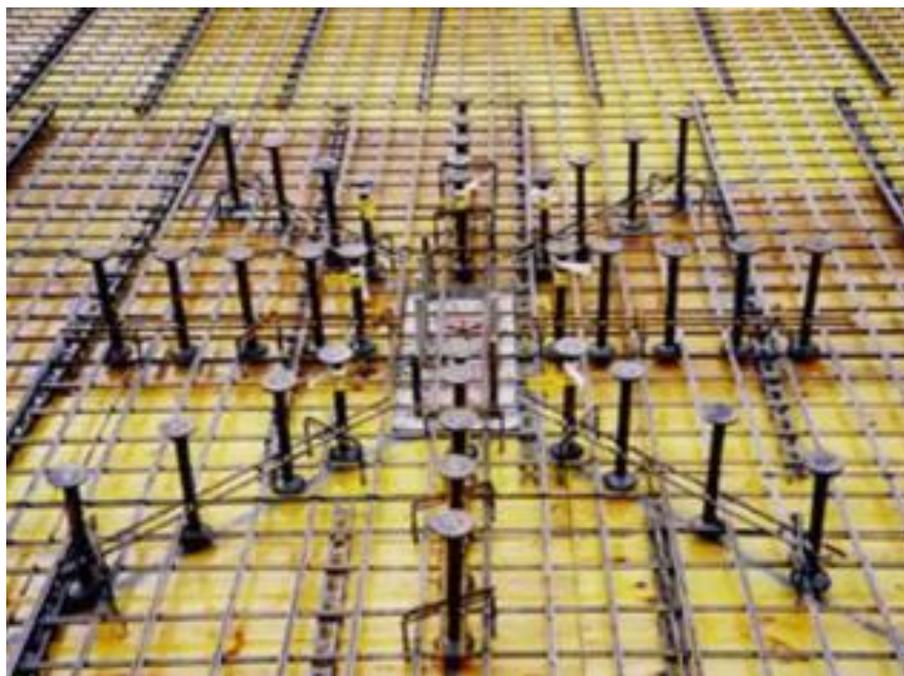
Пример расположения стандартизованных сварных элементов
